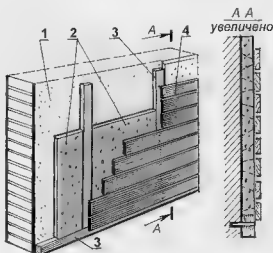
Обшивка стены с добавлением теплоизоляции: 1 — наружная стена; 2 — листы теплоизоляции; 3 — рейка обрешетки; 4 — обшивка досками
